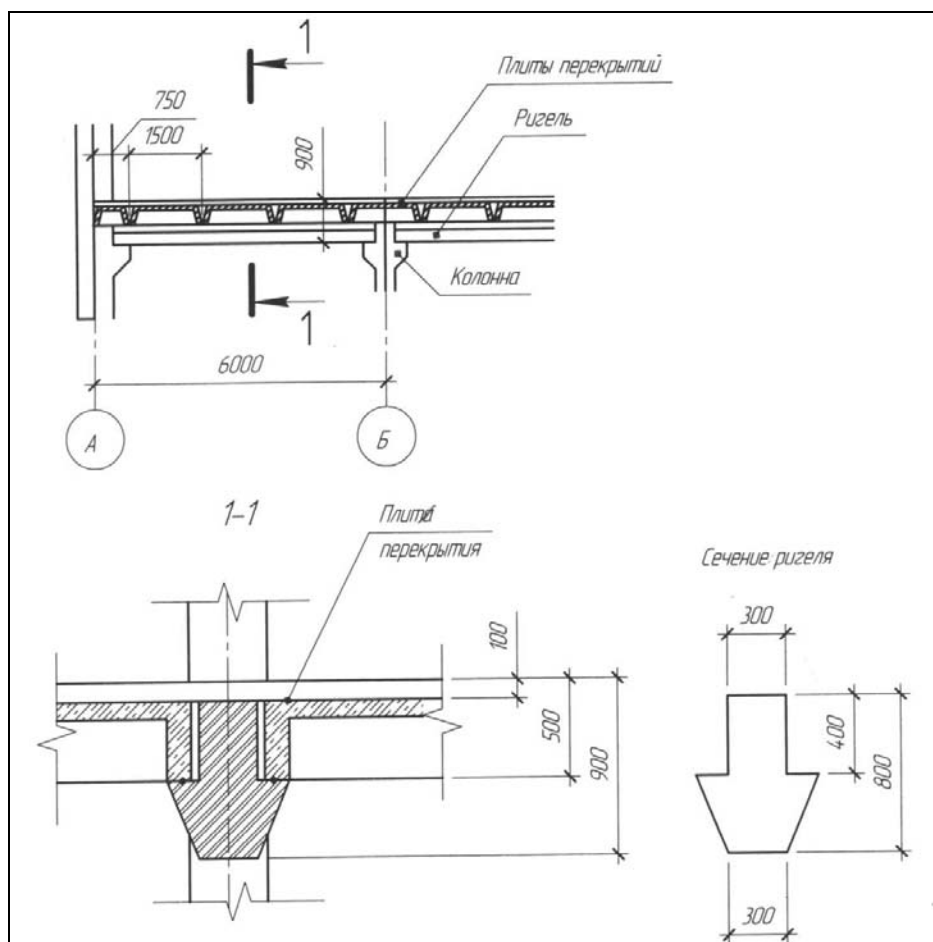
Конструкция междуэтажного перекрытия двухэтажных зданий
